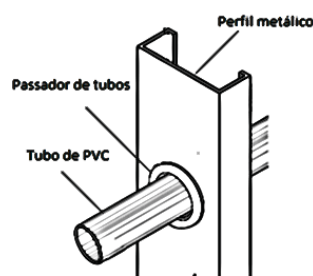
Ilustração da instalação do tubo no perfil metálico vertical com passador de tubos
